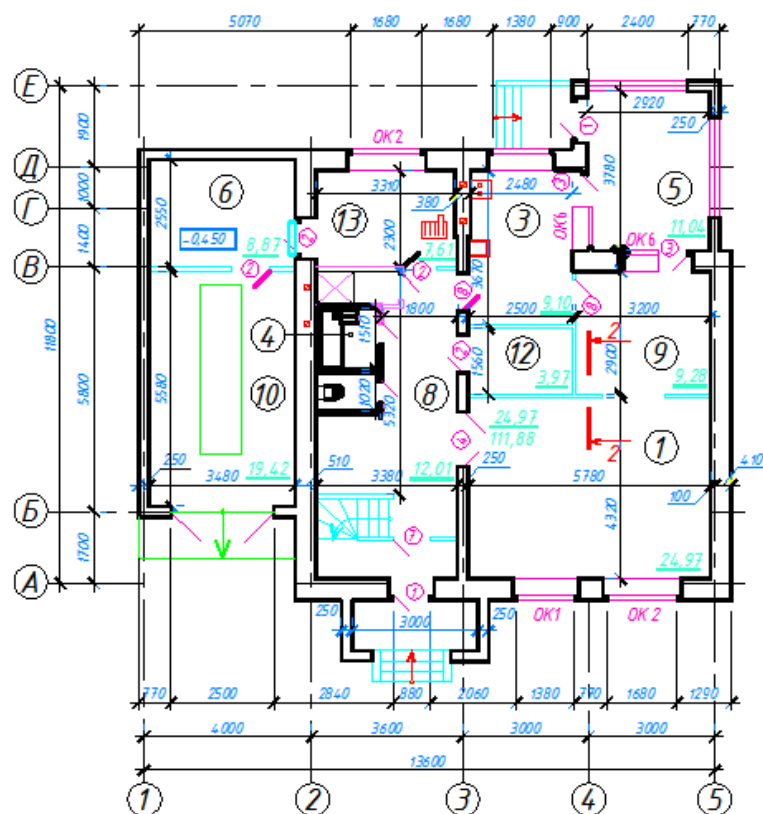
План першого поверху на відмітці 0,000 м
